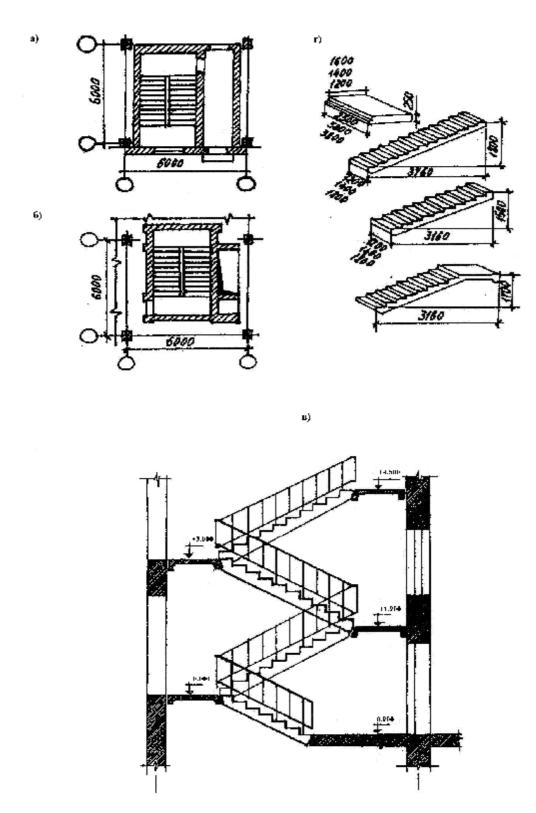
Лестницы многоэтажных зданий (а – лестничная клетка с вестибюлем; б – лестничная клетка внутри здания с вентиляционной шахтой; в – лестничная клетка, разрез; г – типовые элементы лестницы: площадки и марши)
